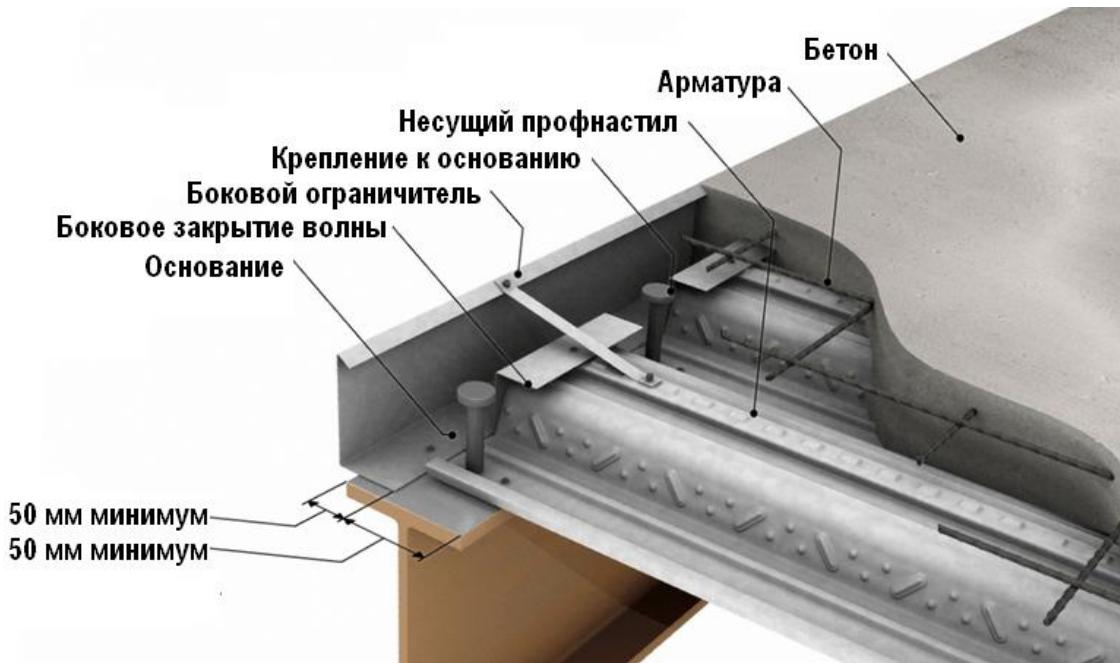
Устройство монолитного железобетонного перекрытия по металлическим балкам [1]
